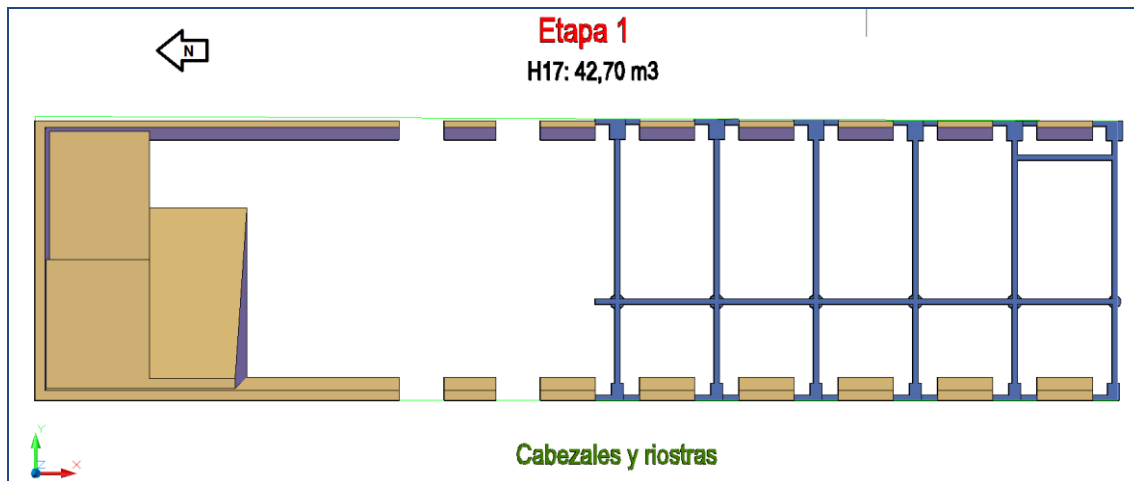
Planta de cabezales y vigas riostras en donde se indican en azul las vigas riostras hormigonadas en la primera etapa.
